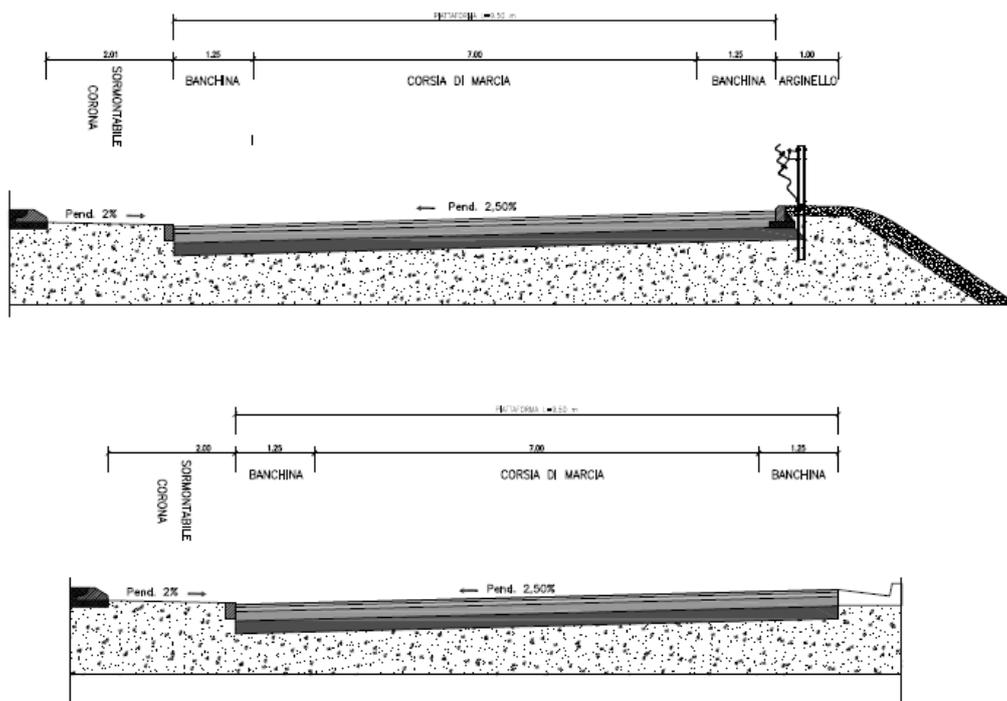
Rotatoria asse secondario – Sezione tipo
